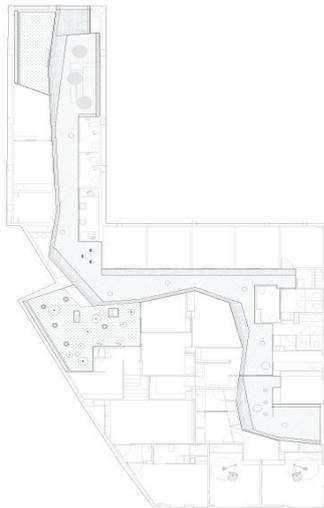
Planta baixa – Detalhe corredor – Clínica IOC, Las Palmas, LP, Espanha.
